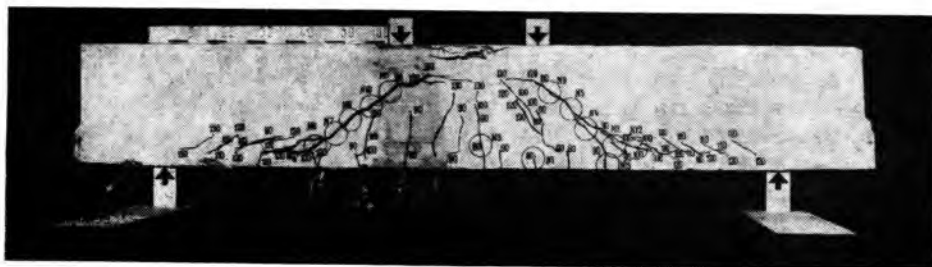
Схемы развития наклонных трещин и разрушение в преднапряженных железобетонных элементах
